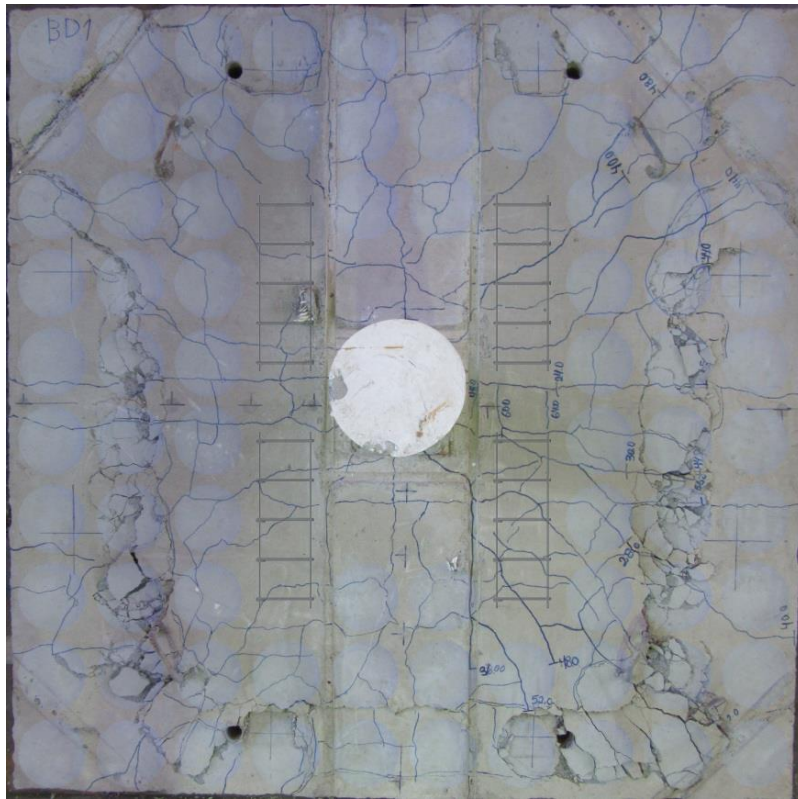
Mapa de fissuração da laje BD1
